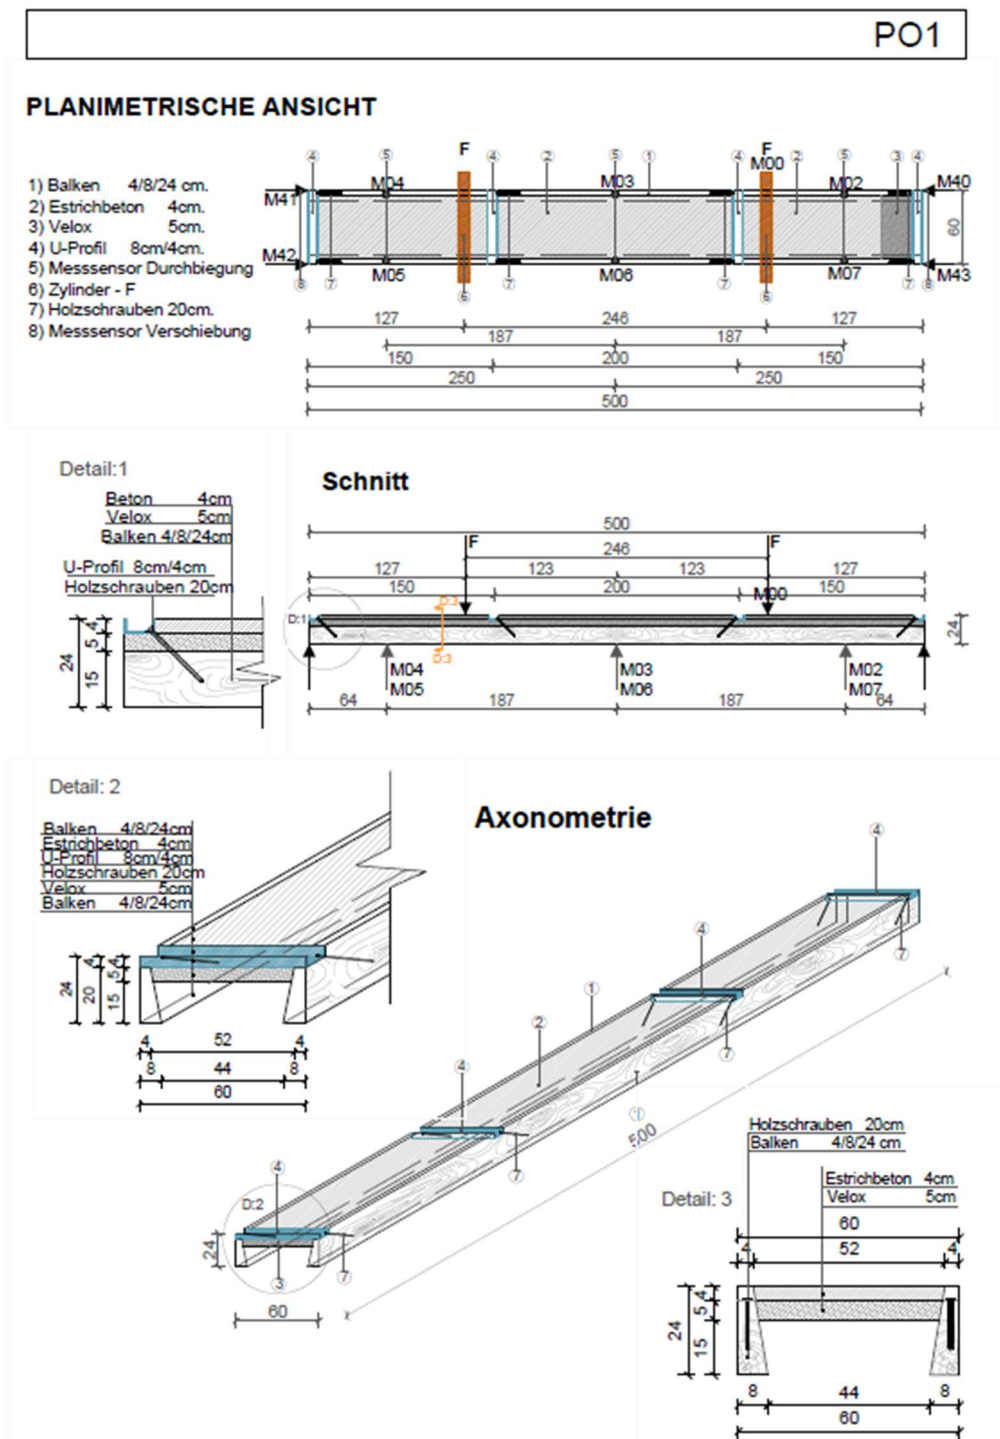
Planimetrische und axonometrische Darstellung des Bauteils P01/P01A einschließlich der Bauteil-Schnitte.
